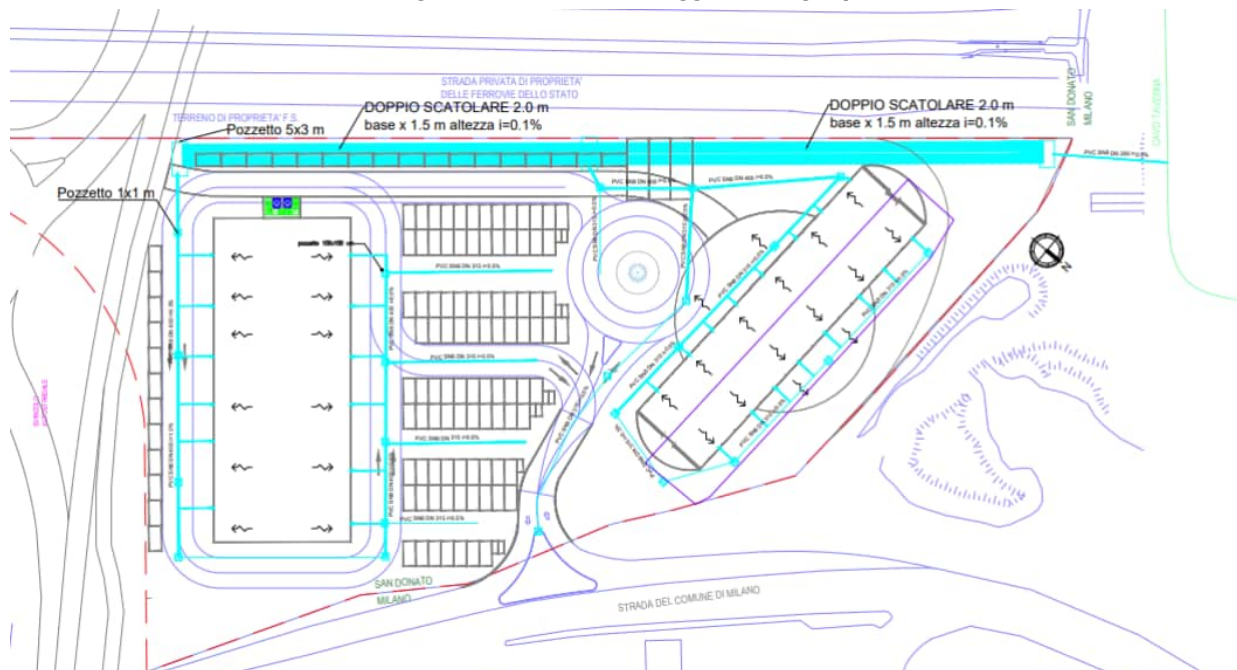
Rete di drenaggio con Vasca di Laminazione
